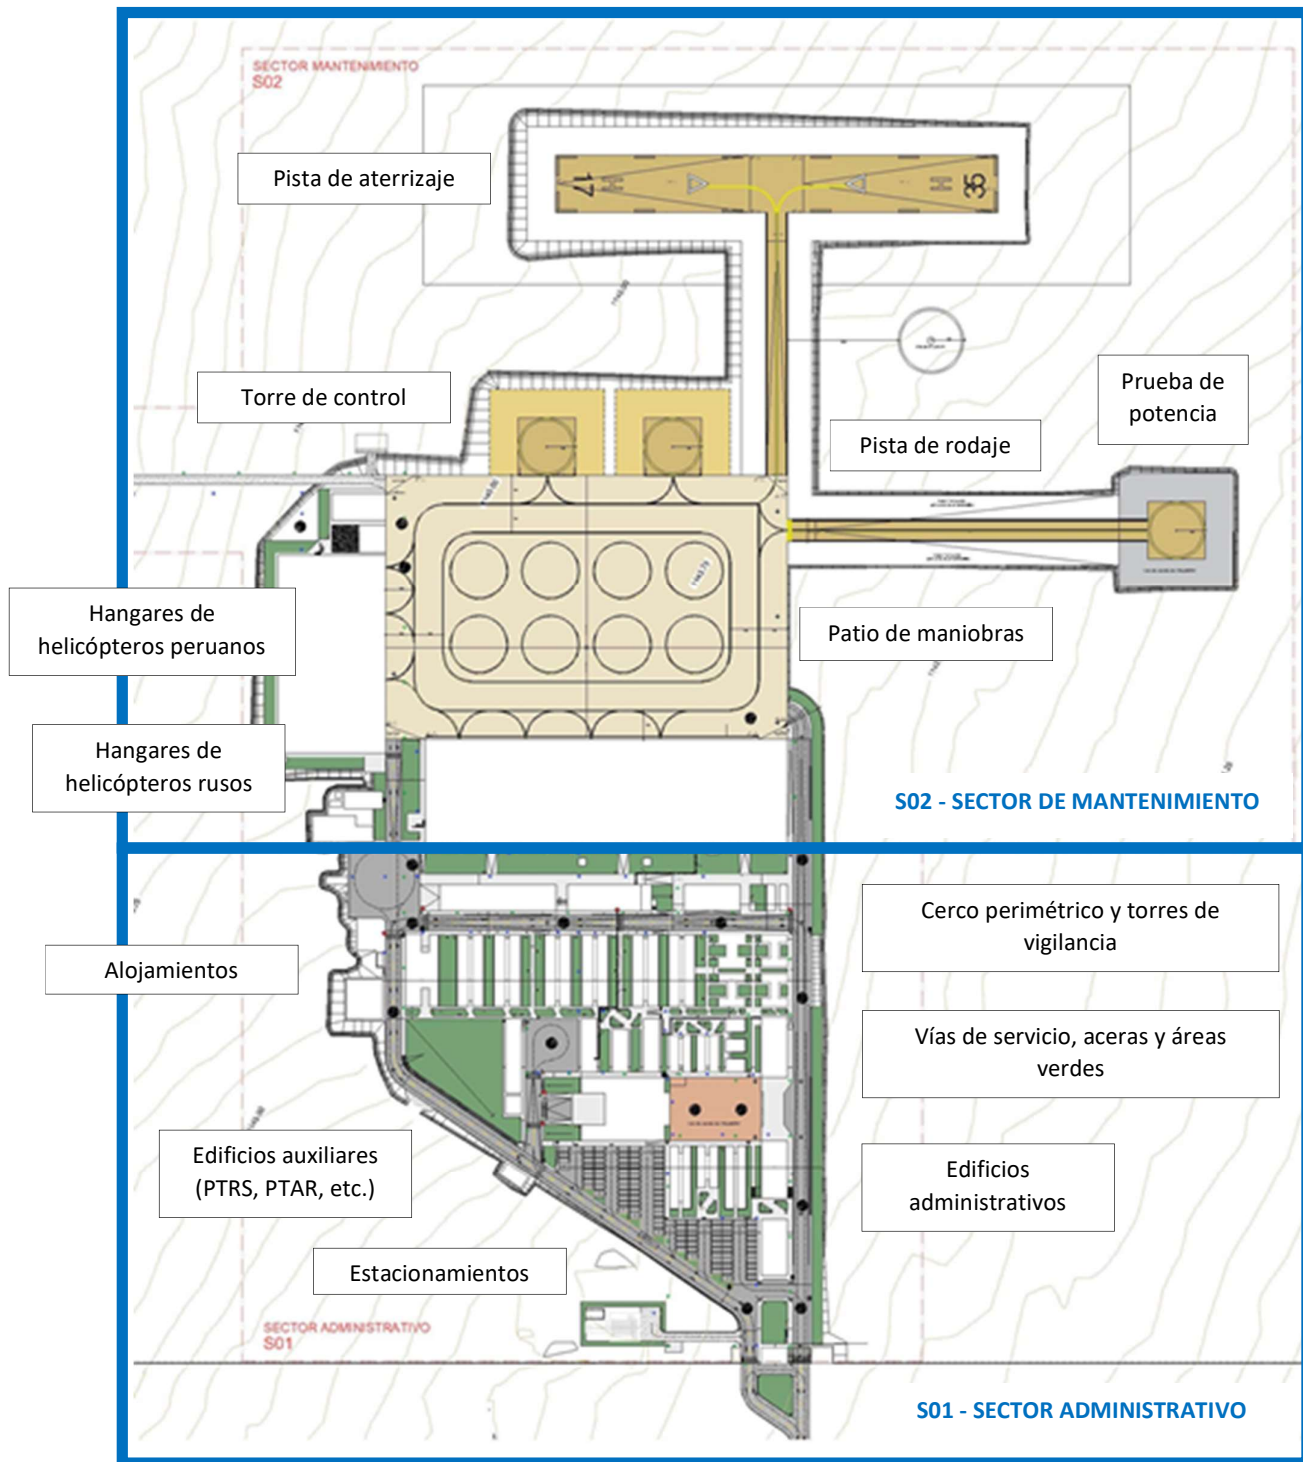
Componentes del proyecto en 2D. Extraído del Expediente técnico.
